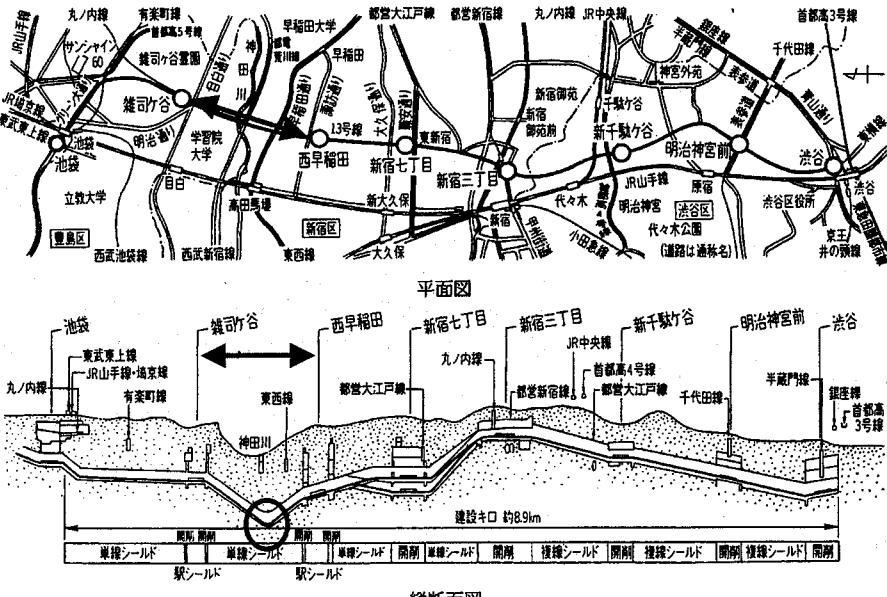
地下鉄 13 号線路線平面・縦断図¹⁾に加筆
